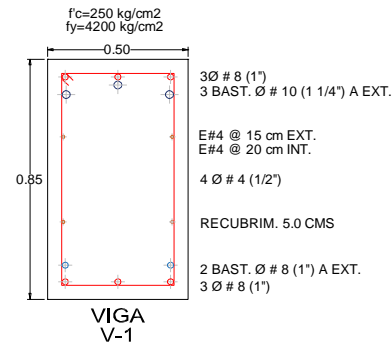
Detallado de armado de vigas y columnas del marco de 9 niveles con base a la hipótesis de las NTCC-04.
